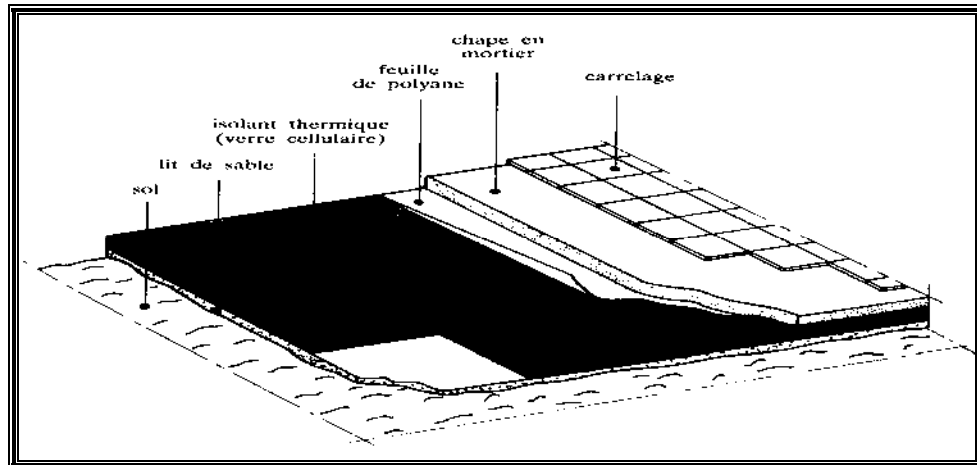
Protection d'un plancher sur terre-plein contre l'humidité ascensionnelle et de condensation
